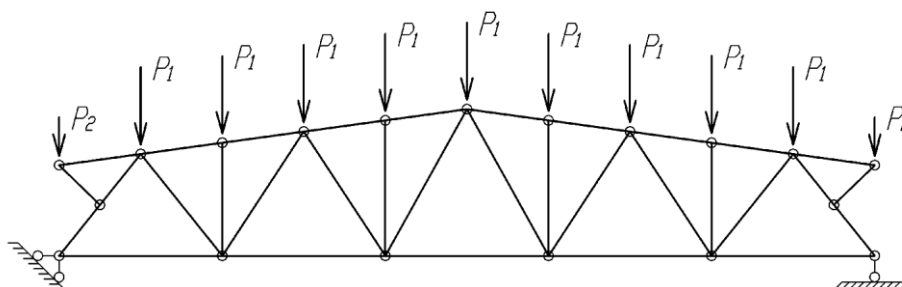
Расчетная схема фермы с нагрузкой от собственного веса кровли.
